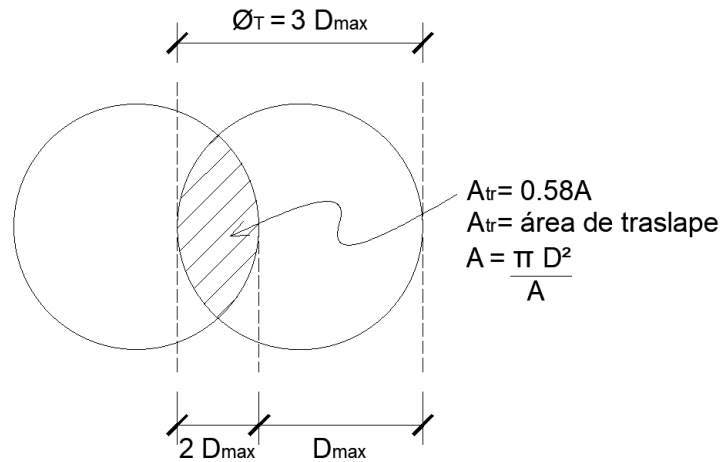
Área de traslape del apoyo desplazado para un aislador circular.
